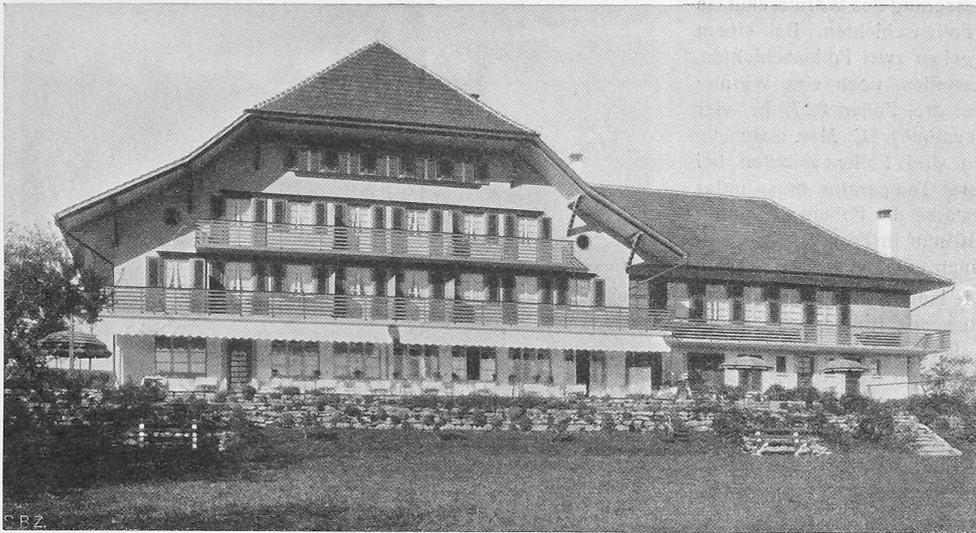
bis 9. Strassenfront und Grundrisse 1:400.
